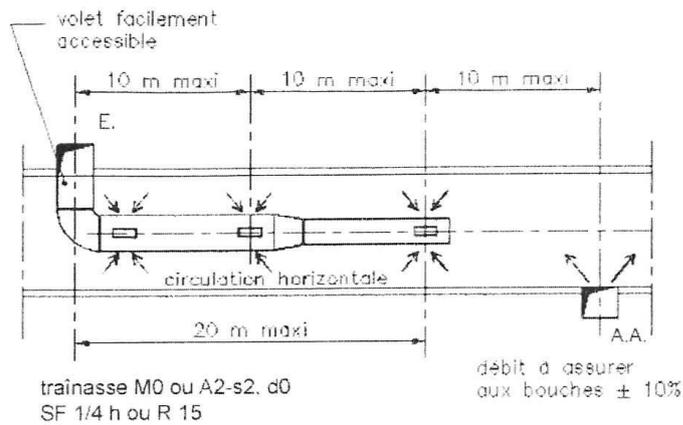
implantation des bouches d'amenée d'air et d'extraction dans les circulations horizontales, extraction par trainasse en plafond.
